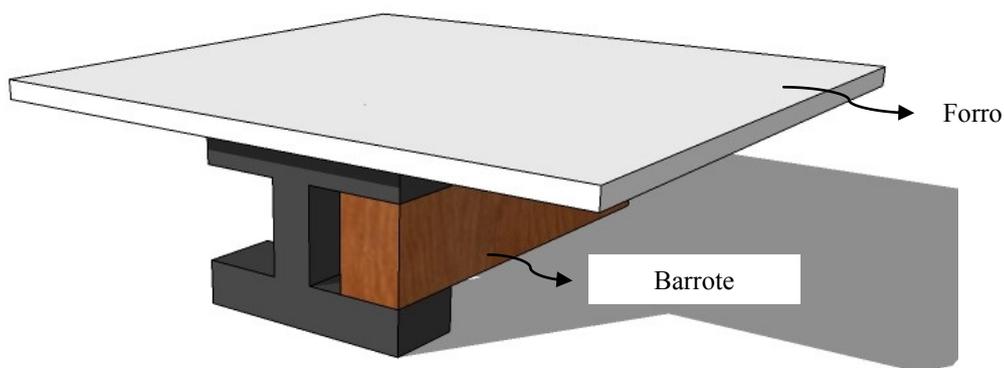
Detalhe construtivo – trilhos duplo T.
